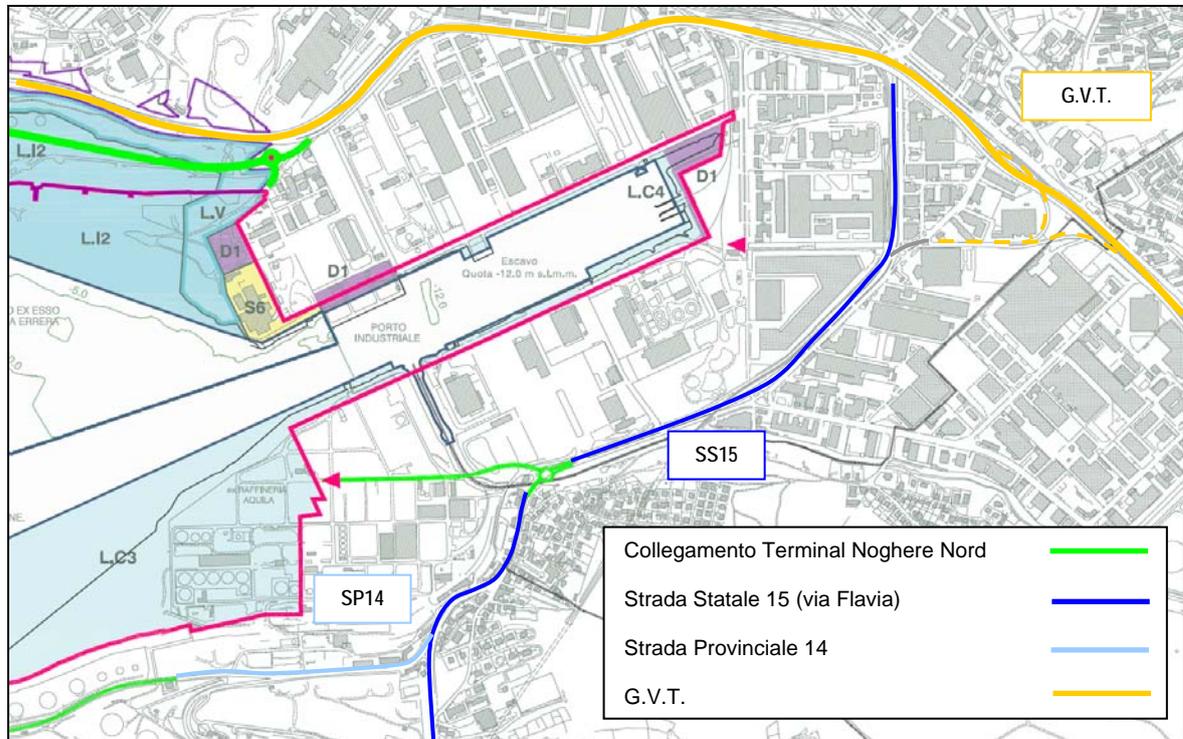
LOCALIZZAZIONE TRACCIATO COLLEGAMENTO NORD
